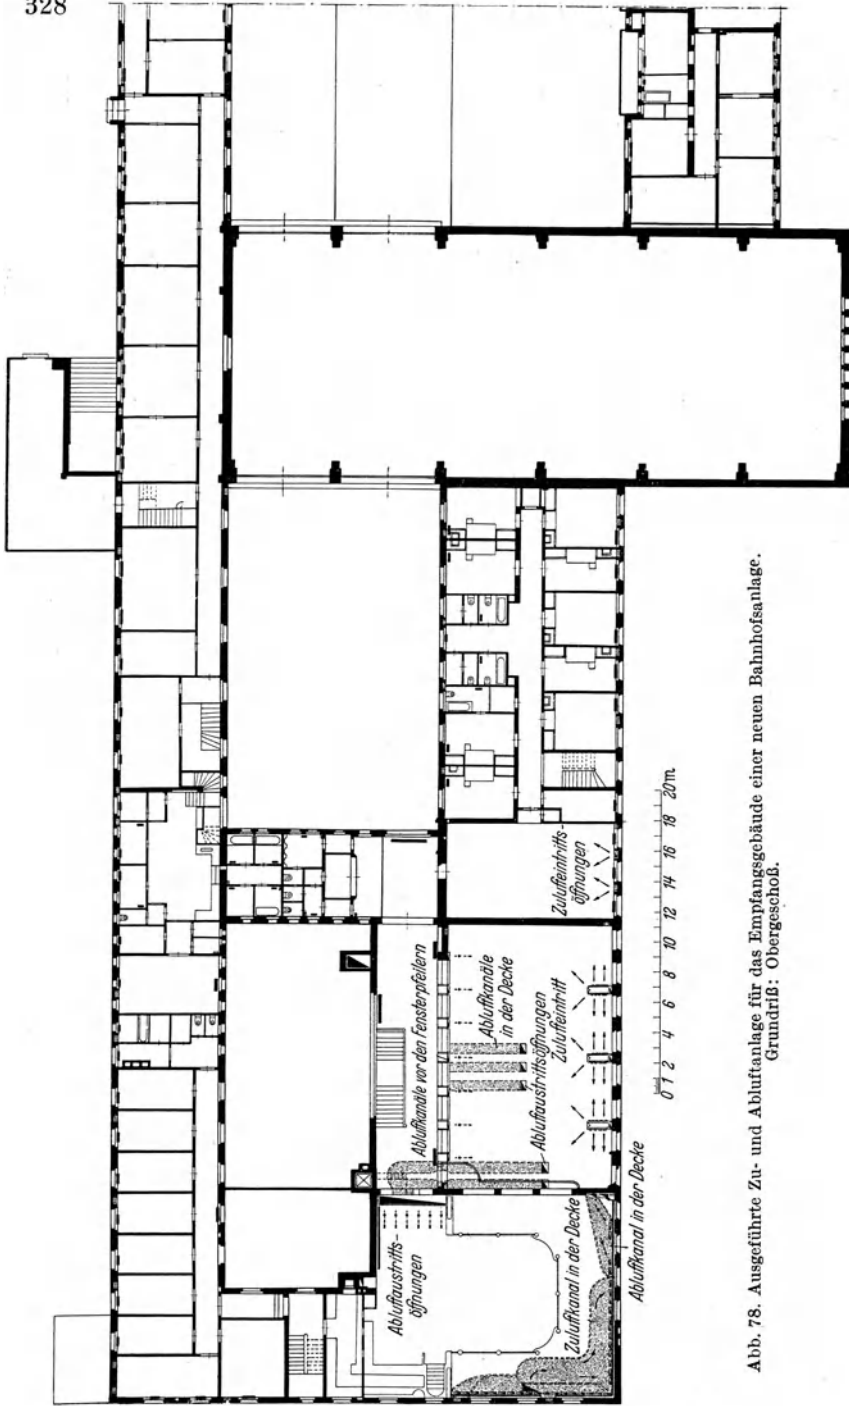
Ausgeführte Zu- und Abluftanlage für das Empfangsgebäude einer neuen Bahnhofsanlage.
